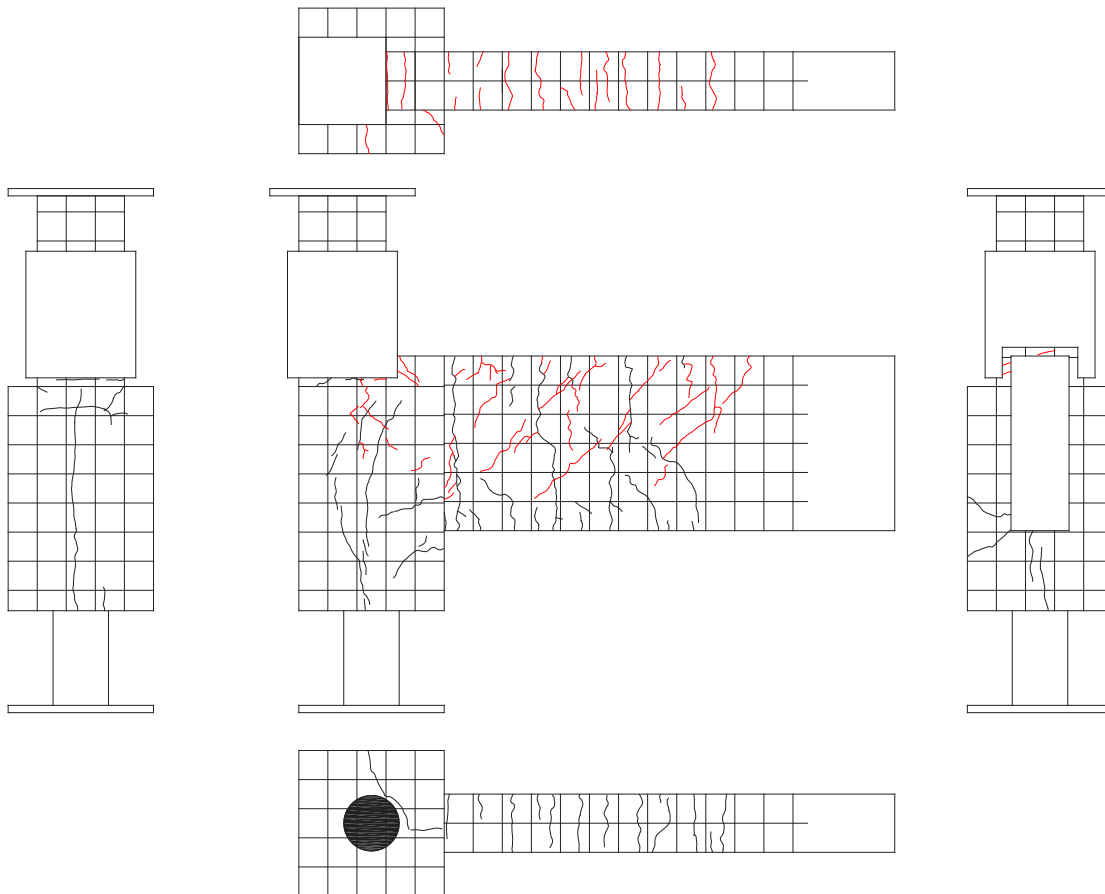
3. 94 試験体 C-2 ひび割れ状況 (3Cycle)
